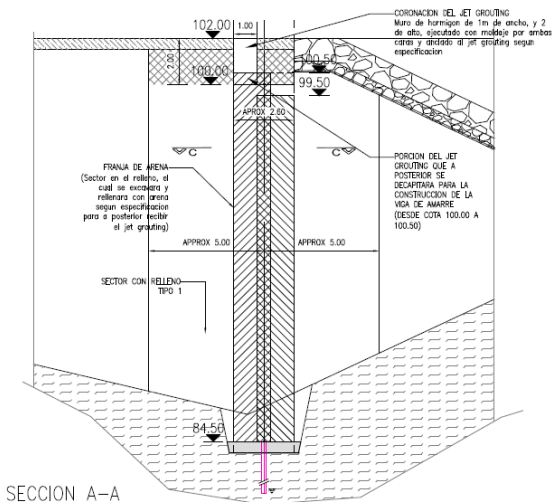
Vista en Corte Transversal de la Pantalla de Jet Grouting.
